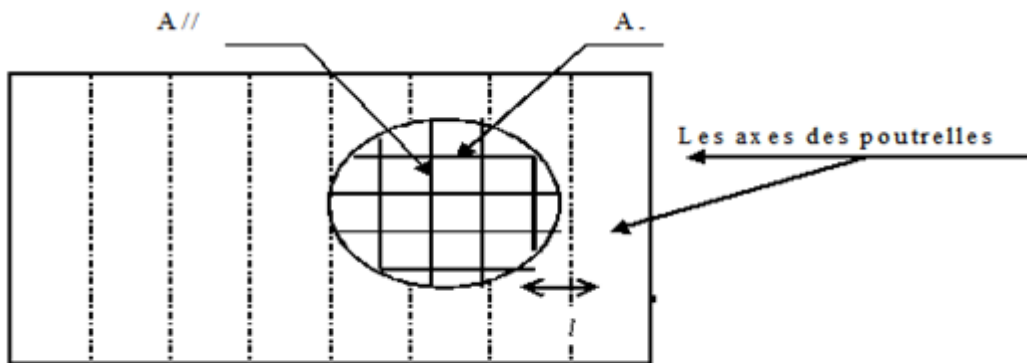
Section minimale des armatures perpendiculaires aux poutrelles
